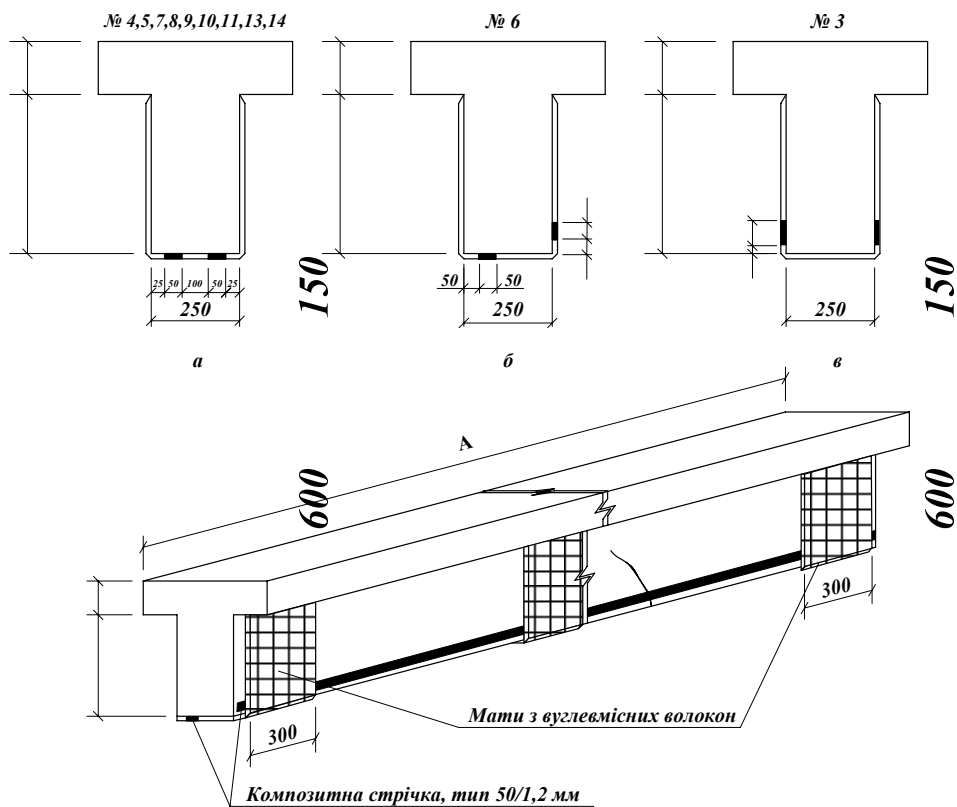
Схема влаштування посилення композитними стрічками S&P CFK – Lamellen Sheet
